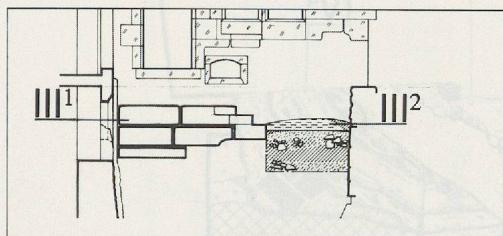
Cour haute, la façade est avec l'escalier III¹ (éch. 1:150).
